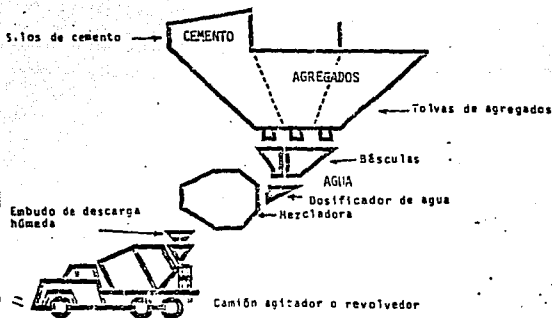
PLANTA DE CONCRETO CON MEZCLADO EN PLANTA
